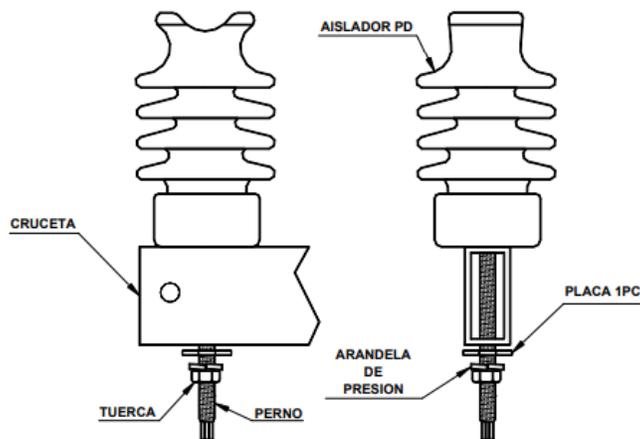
Instalación de aislador PD en cruceta
